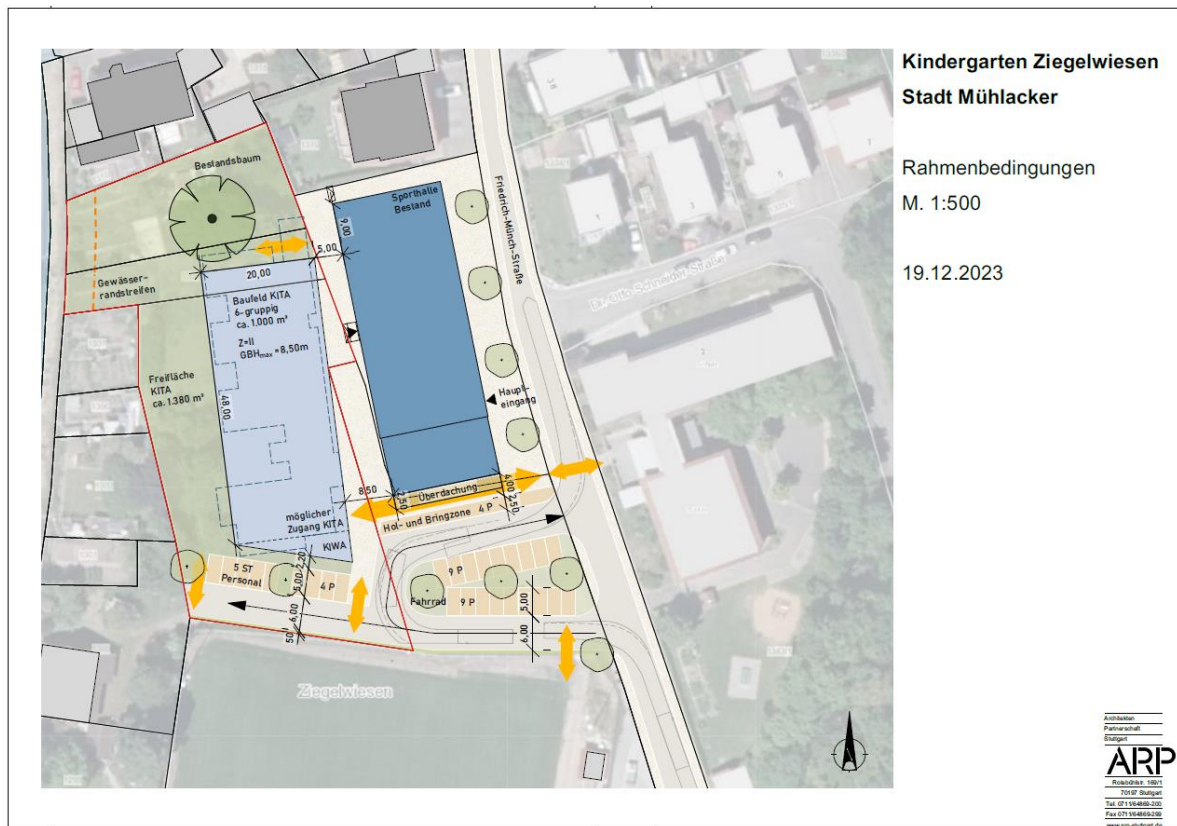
Rahmenplan zum Bebauungsplan Kindergarten Ziegelwiesen der Architekten Partnerschaft Stuttgart. Stand 25.06.2024
